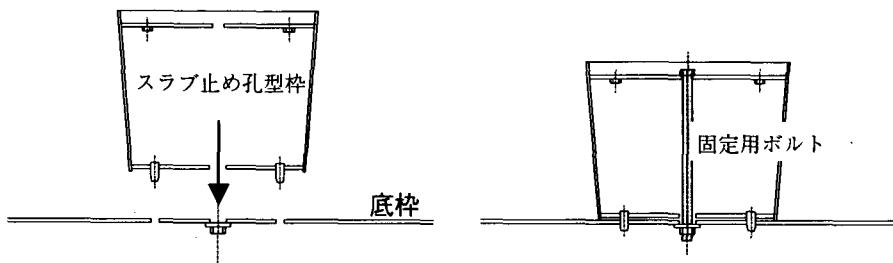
スラブ止め孔型枠の固定方法の例
